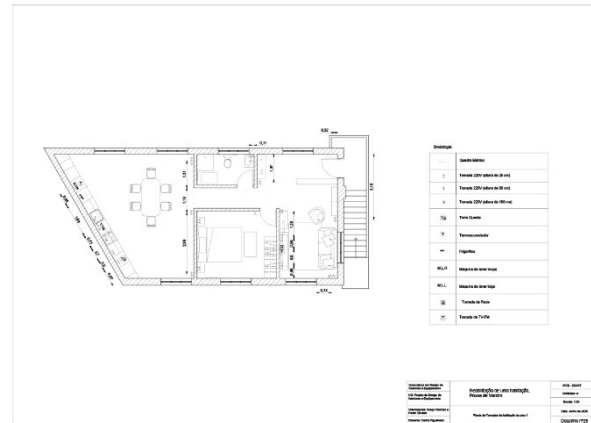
Planta de Tomadas Habitação Piso 1. Fonte: Autor.
